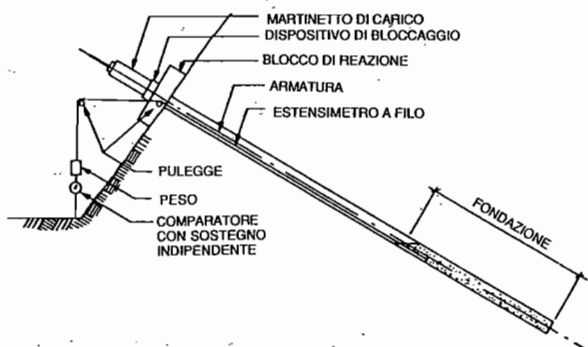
Metodo diretto per la misura dei movimenti della fondazione.
